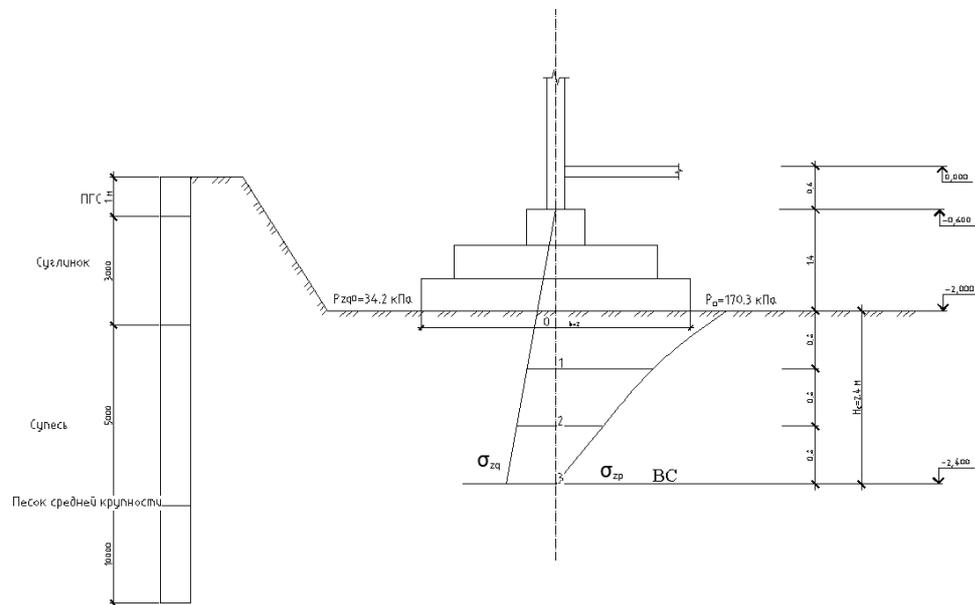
К расчету осадки фундамента мелкого заложения колонны среднего ряда
